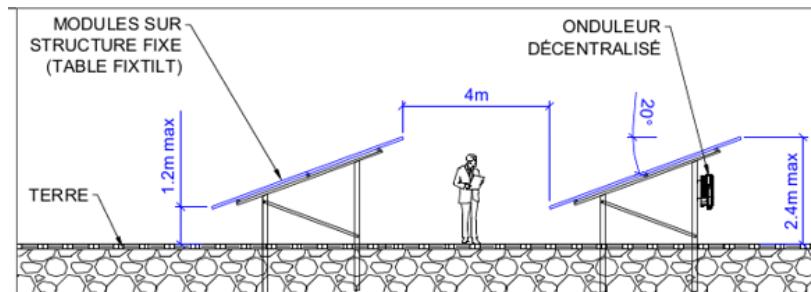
Schéma de la structure des panneaux fixtilt bi-pieux
